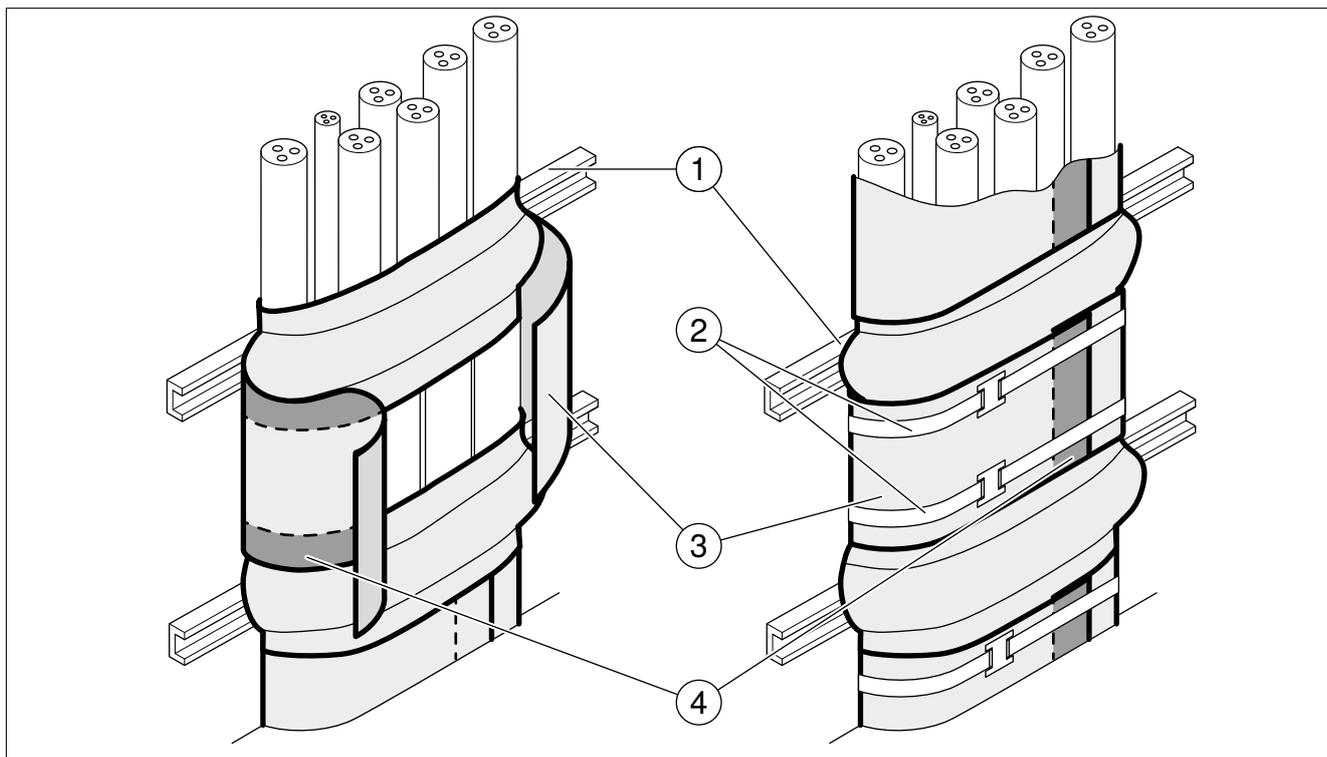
Enrubannage coupe-feu autour d'une échelle à câbles
